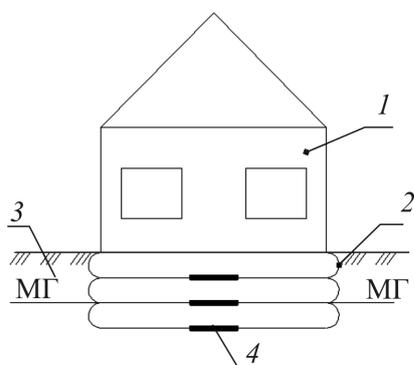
Грунтонаполняемые основания: 1 – здания; 2 – грунтонаполняемые оболочки; 3 – деятельный слой грунта; 4 – демпферные узлы
